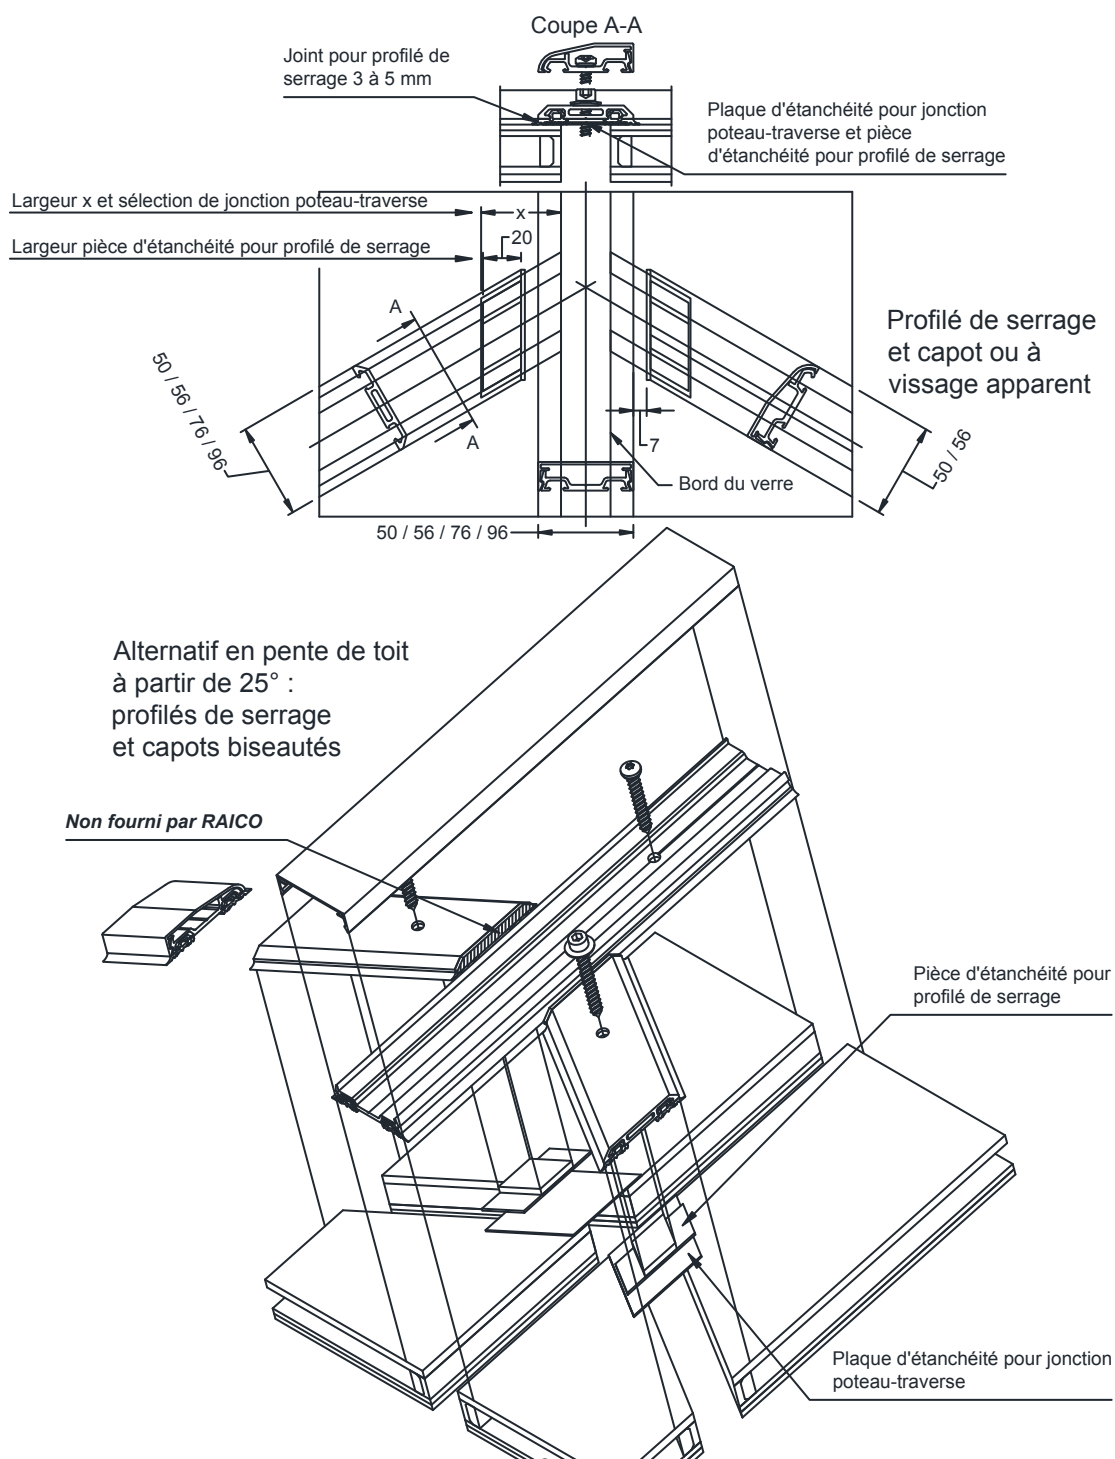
Plaques d'étanchéité et pièces d'étanchéité de profilé de serrage pour raccordement en biais : serreur + capot / serreur plat de 7 mm
